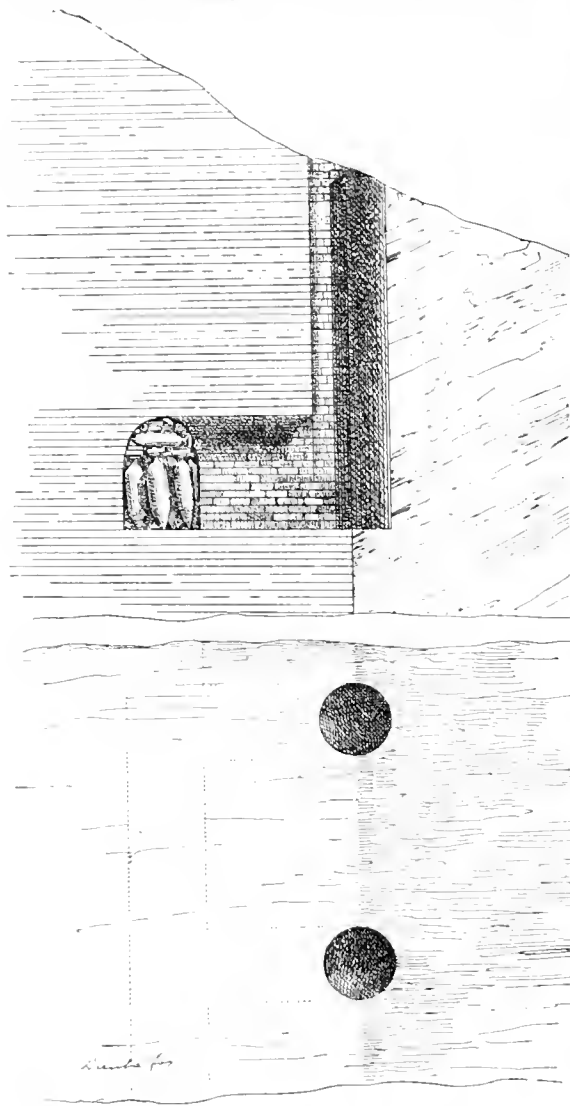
PLAN ET COUPE D'UN Puits FUNÉRAIRE.
